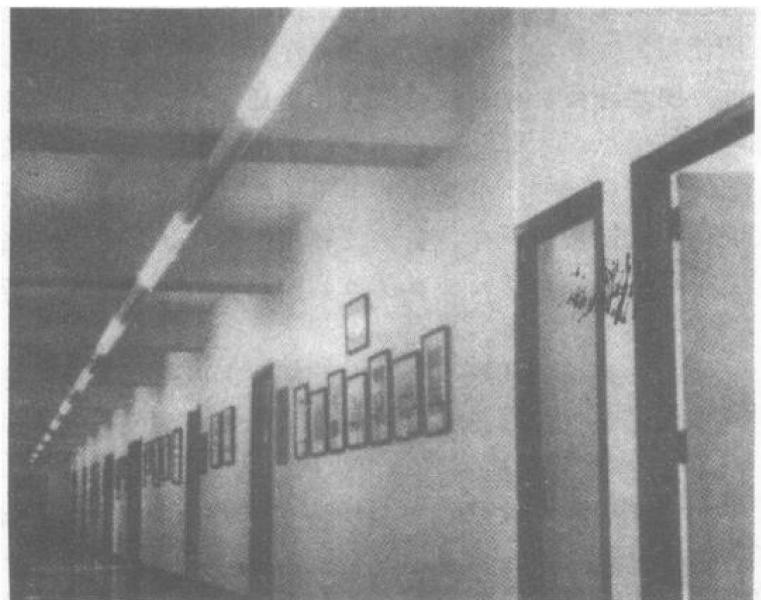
整浇梁支承的单向钢筋混凝土楼板
